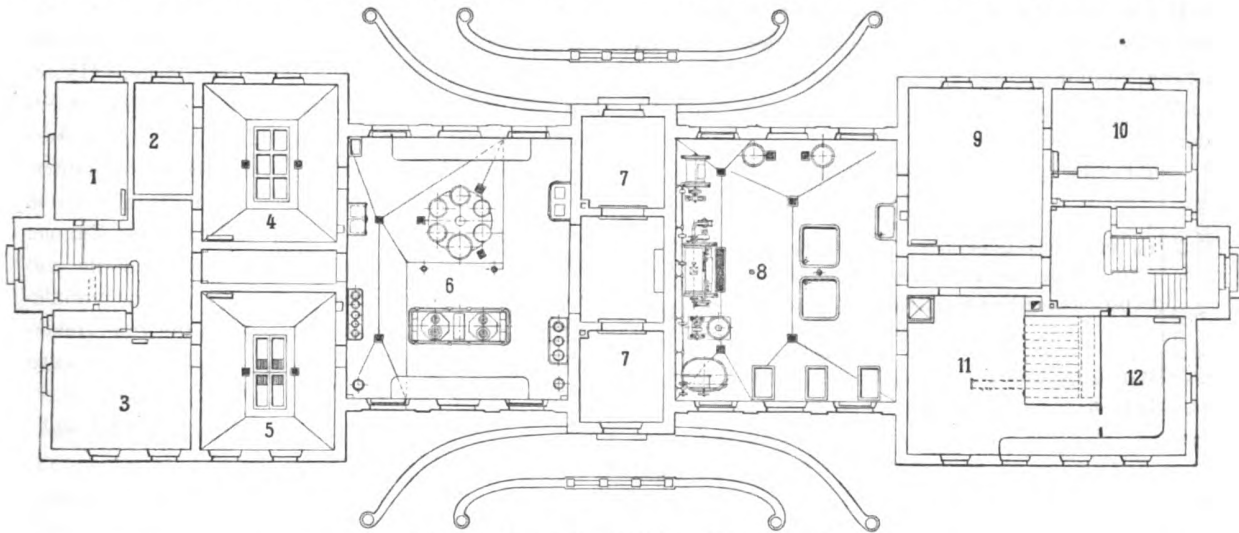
Grundriss des Wirtschaftsgebäudes.
